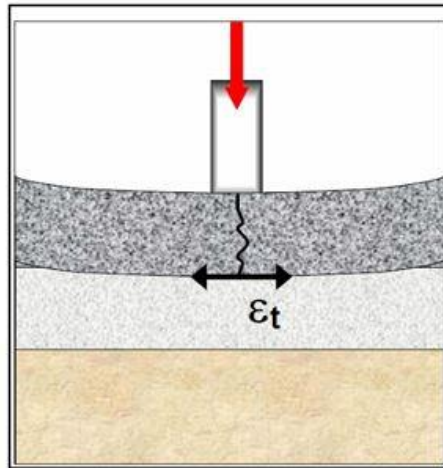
Mécanisme de fissuration par fatigue dans les chaussées bitumineuses [23]
